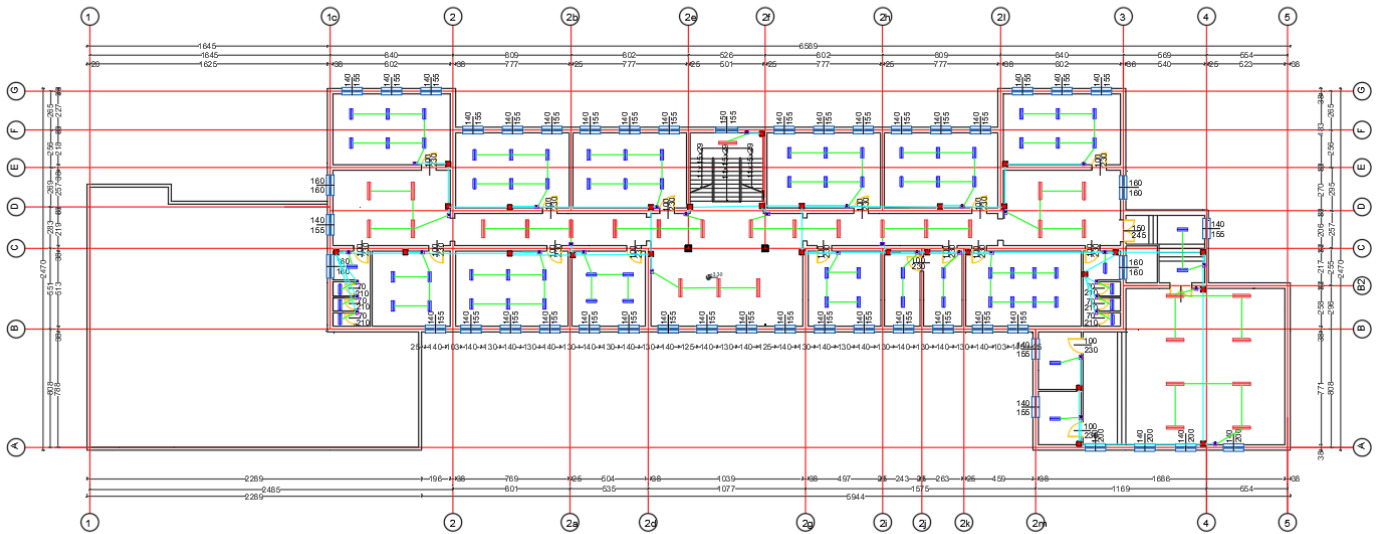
Planimetria e instalimeve elektrike, kati i I-re
